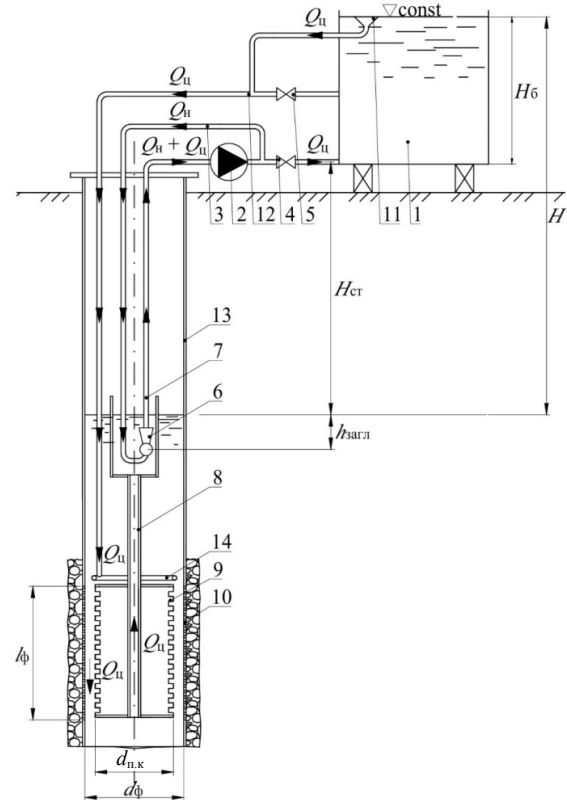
Вариант I – струйный и реагентный насосы работают последовательно: 1 – емкость с реагентом; 2 – реагентный насос; 3 – подводящий нагнетательный трубопровод; 4, 5 – вентили; 6 – струйный насос; 7 – отводящий трубопровод; 8 – водоподъемная колонна; 9 – гофрированная пластиковая труба; 10 – очищаемый фильтр; 11 – слив в виде воронки; 12 – заливочный трубопровод; 13 – фильтровая колонна; 14 – дырчатый кольцевой патрубок
